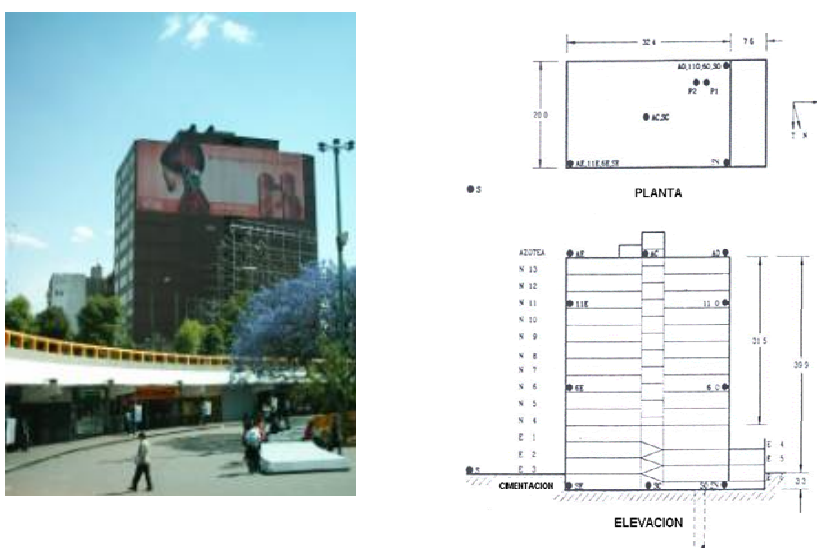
Vista esquemática (planta y elevación) del edificio instrumentado JAL
